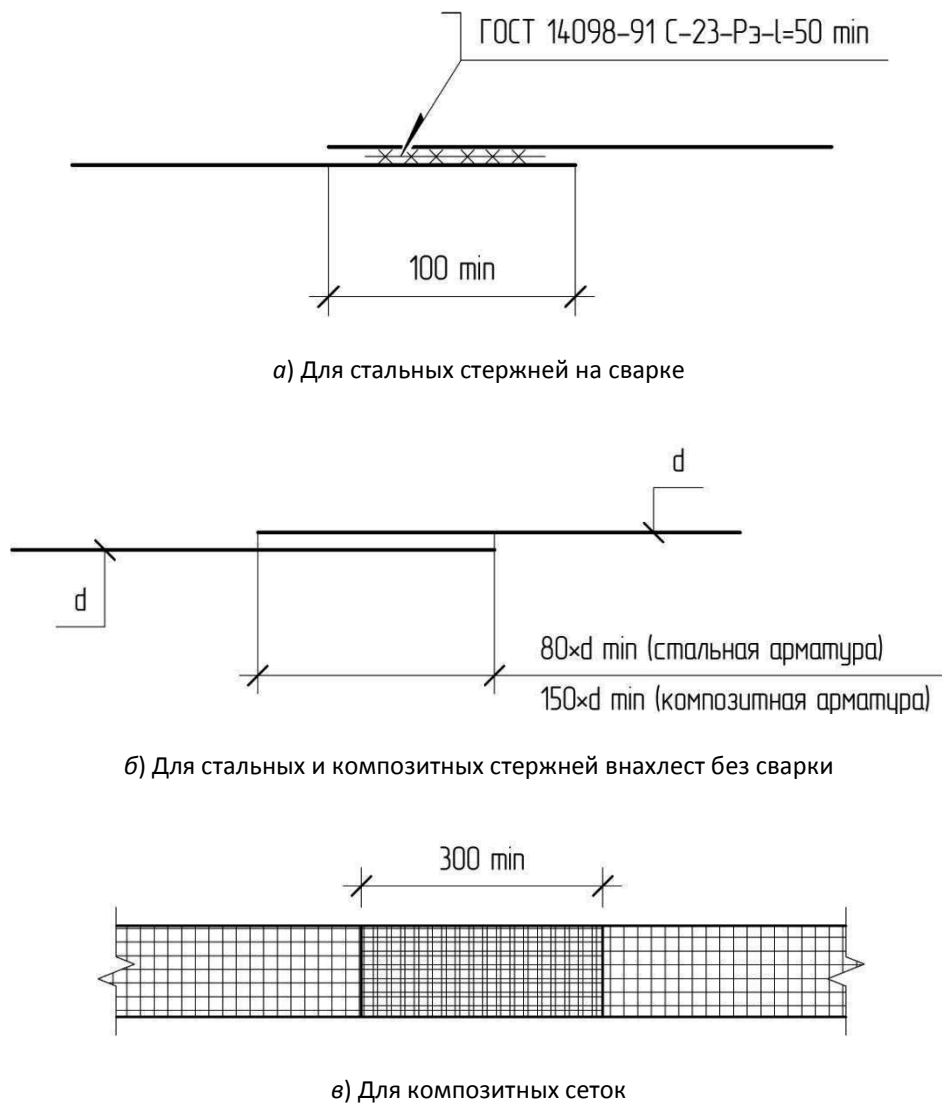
Схемы стыковки арматуры при горизонтальном армировании
